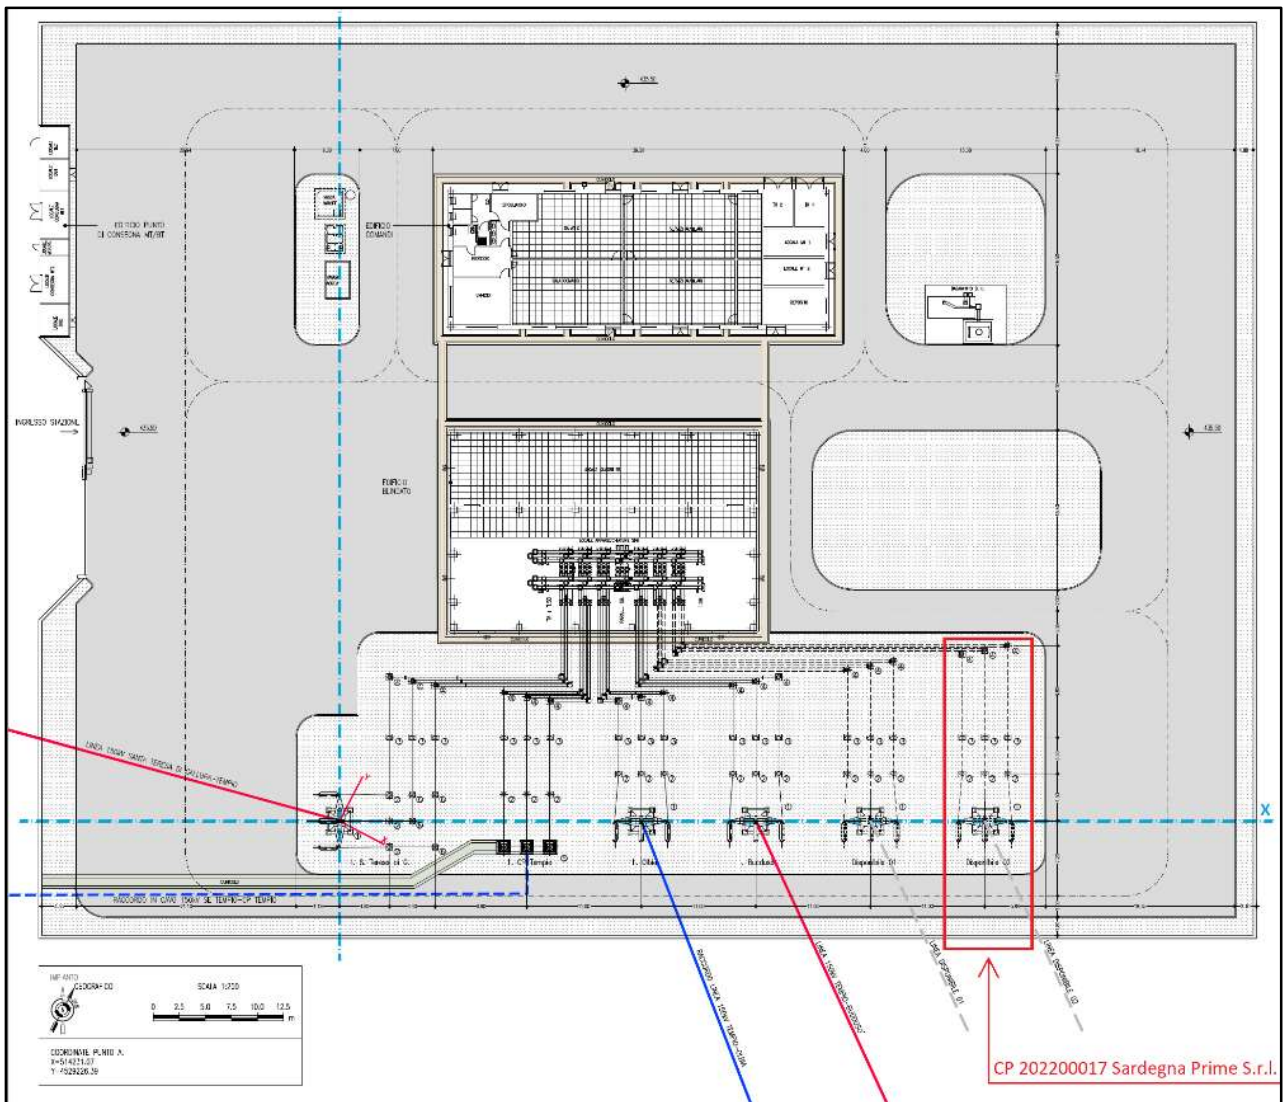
Planimetria della SE RTN a 150 kV “Tempio” con l’ubicazione dello stallo a 150 kV
